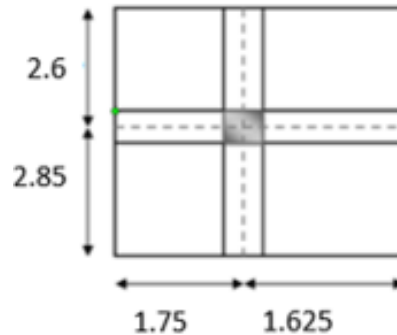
Surface afférente au poteau le plus sollicité.
